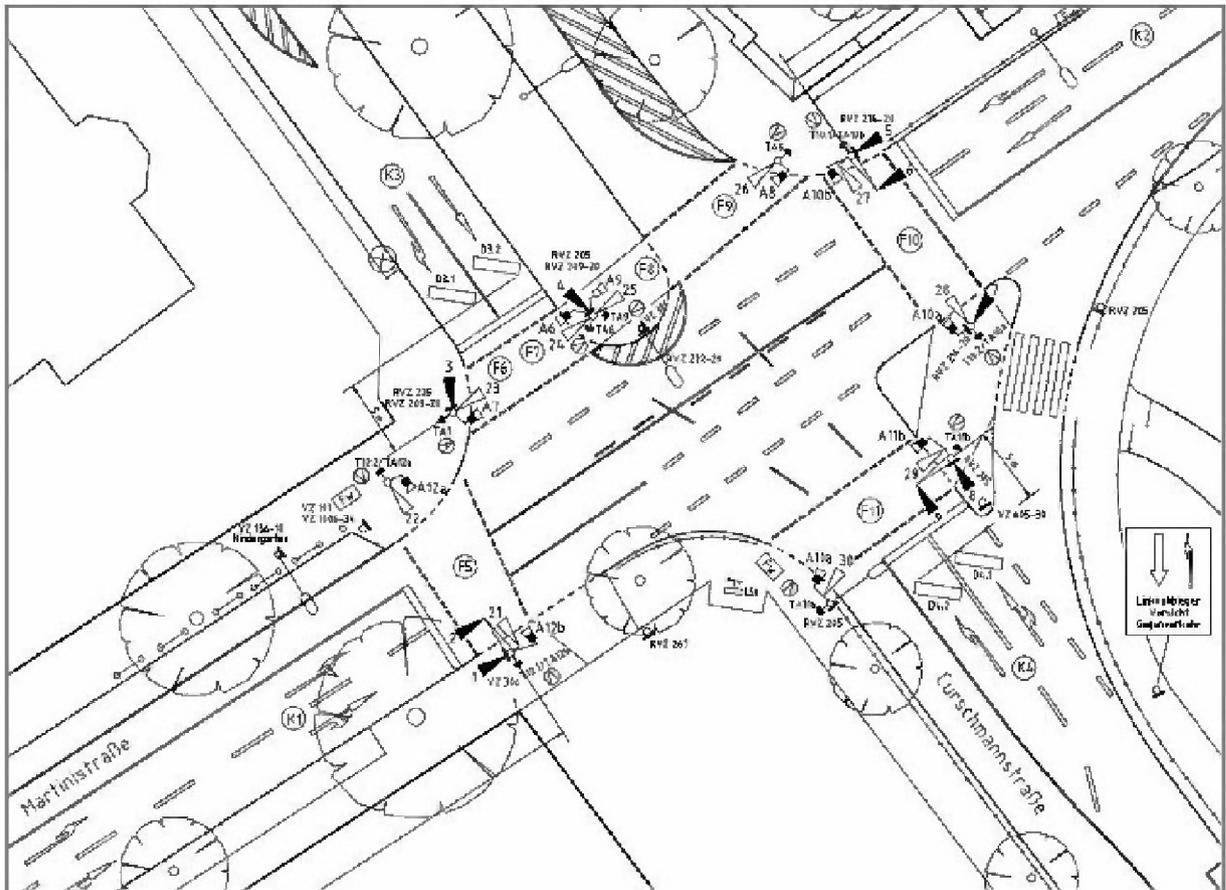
1 Signallageplan der LSA 1705
